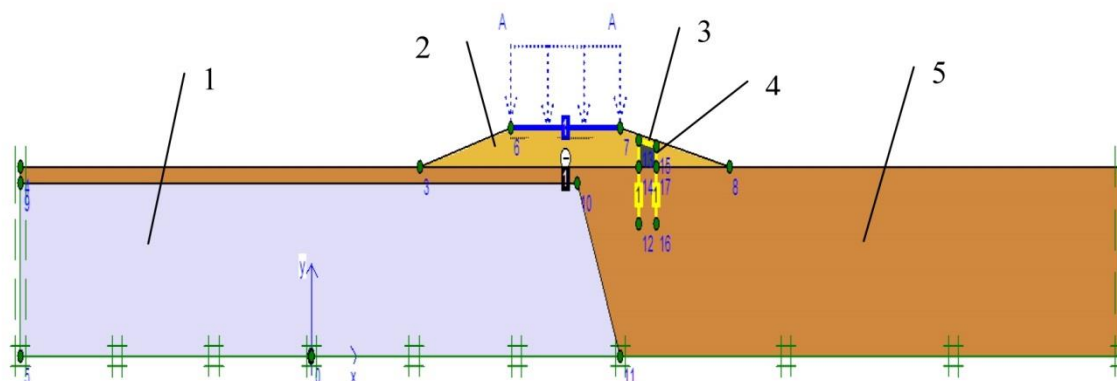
Вариант № 1: Вертикальное армирование откосной части
